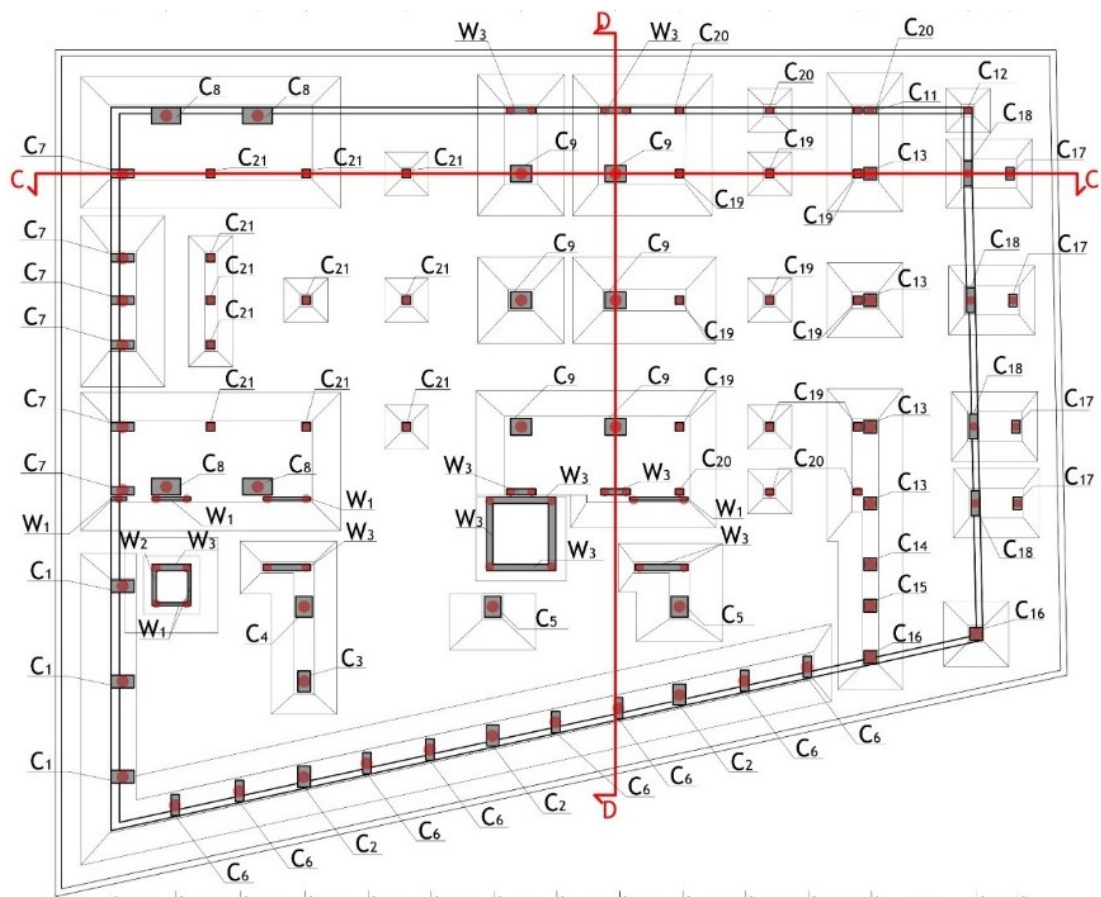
Pianta delle fondazioni dell'edificio arrecante le posizioni degli isolatori, indicate con cerchi rossi
